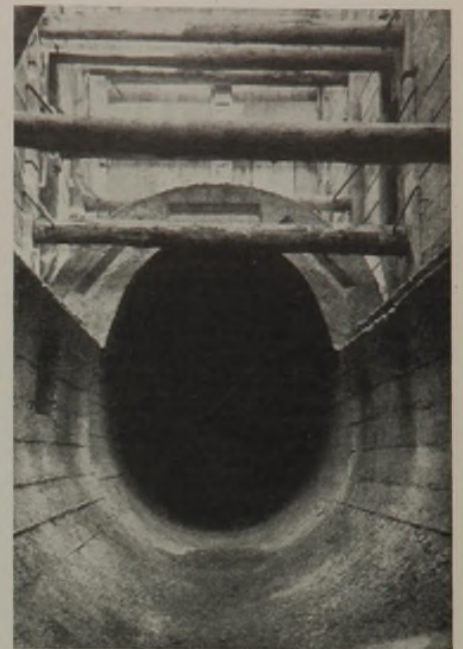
Fertiger Betonkörper des Kanals unter den Eisenbahnanlagen vor Einbringung der Stahlbetonsohle und des Innenputzes.
